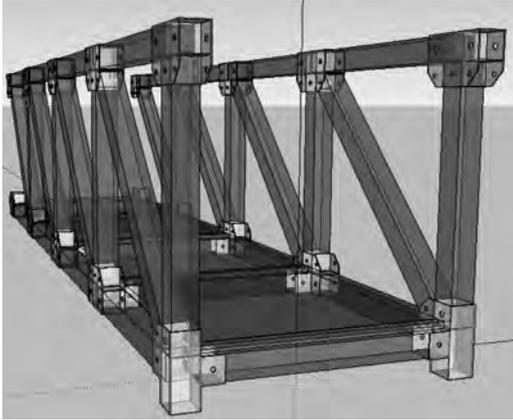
Tipos de conexiones metálicas empleadas en la construcción del puente.
